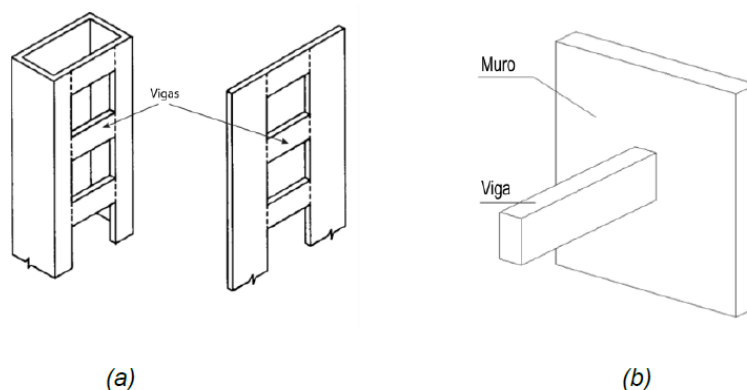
(a) Conexiones dentro del plano o viga de acople. (b) Conexión fuera del plano.
